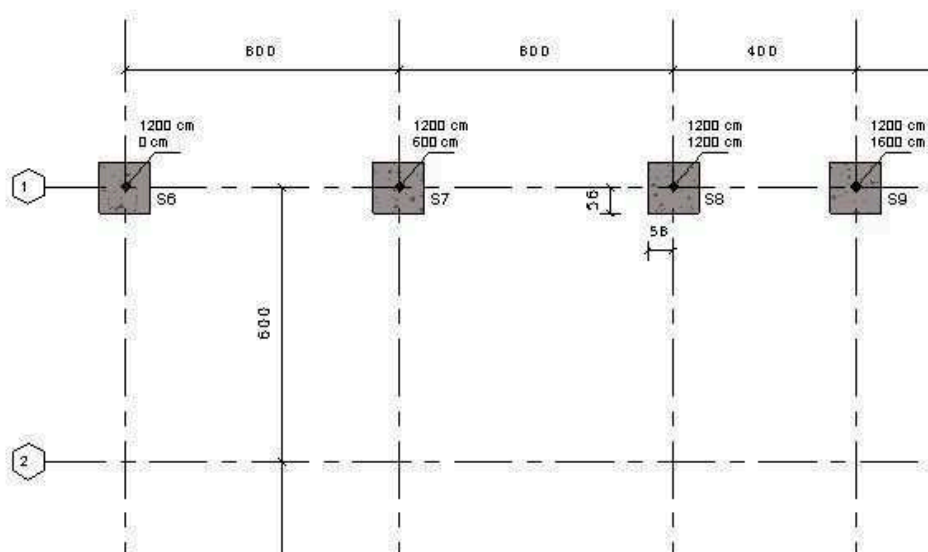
Projeto estrutural - Elementos pré-moldados: Terça, pilar, sapata, viga e braço de cobertura
